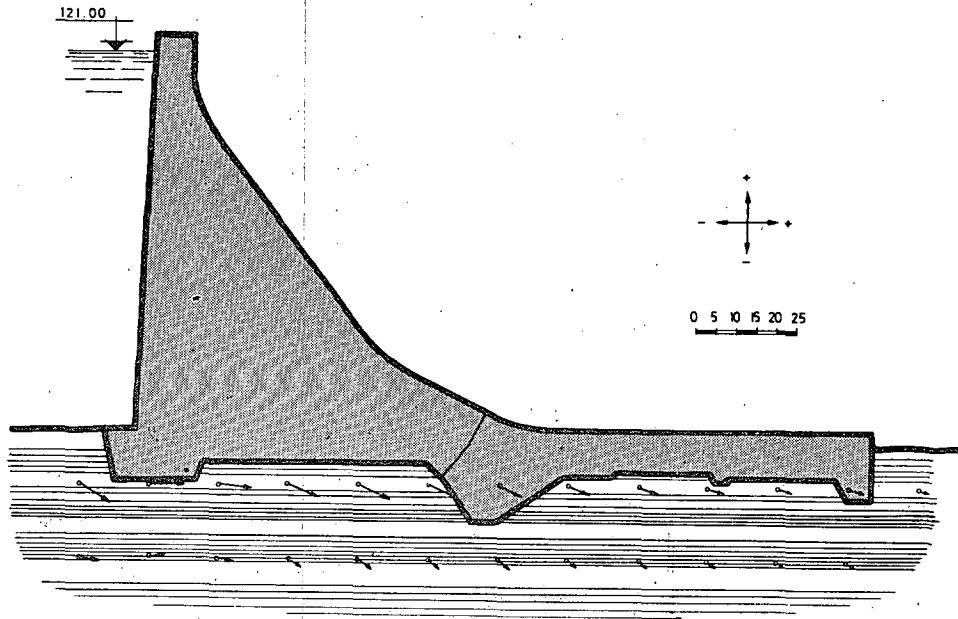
Presa de Mequinenza. Corrimientos en cimentación posteriores al refuerzo.
